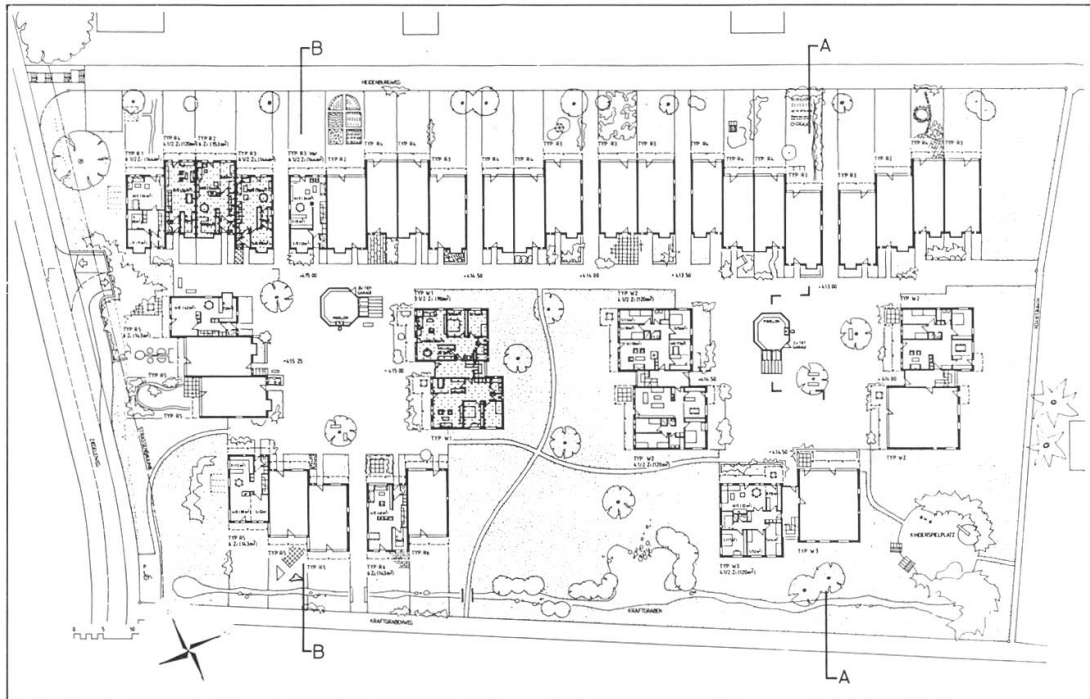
Grundriß Eingangsgeschoß Vorprojekt 1:200 (Umgebungsgestaltung gilt laut Abb. 12)
